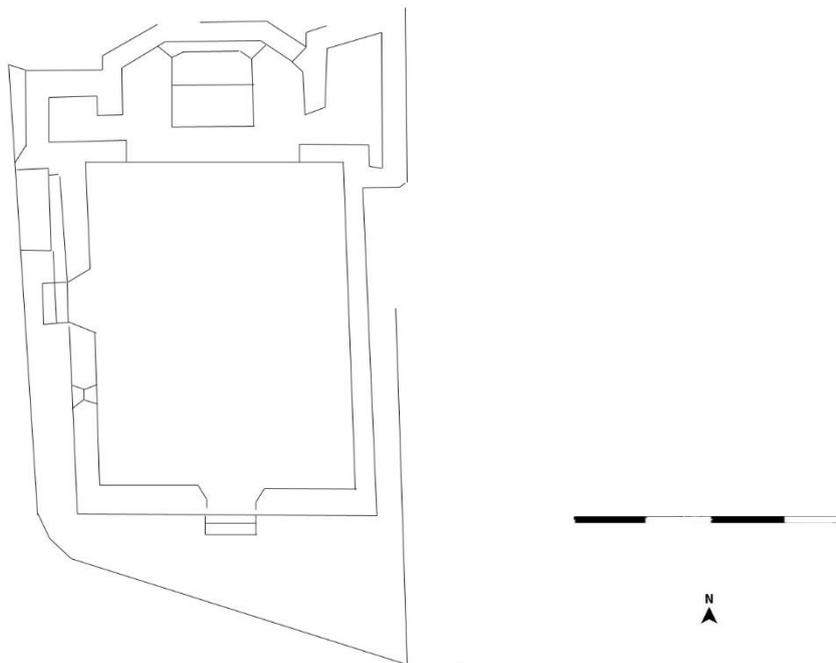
Planimetria della chiesa di Santa Lucia⁷⁷.
